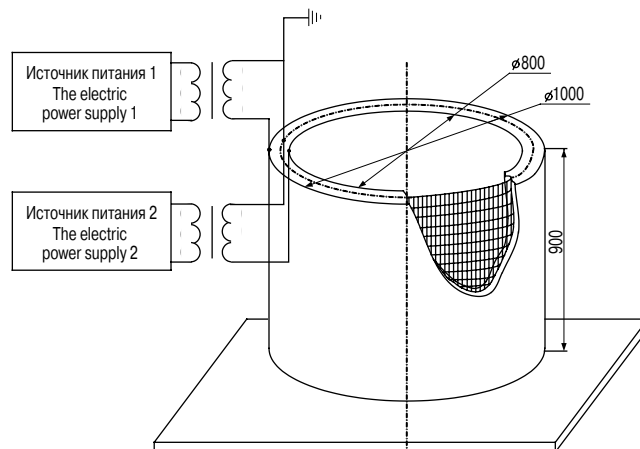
Схема электротепловой обработки железобетонного кольца электродным методом; размеры указаны для изделия – кольцо колодезное железобетонное КС-10-9 – ГОСТ 8020–90
